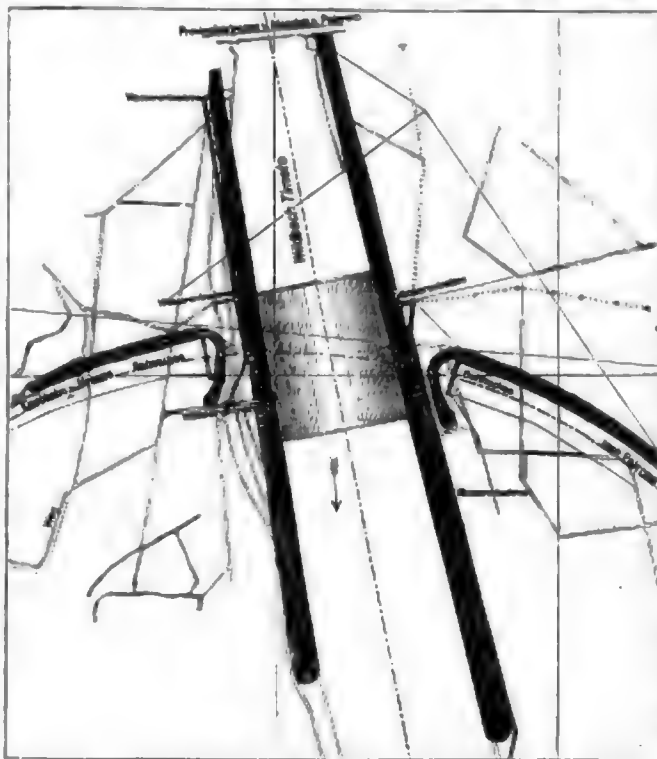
Lageplan der Bahn-Unterführung unter dem Wildwasser Timeto.
